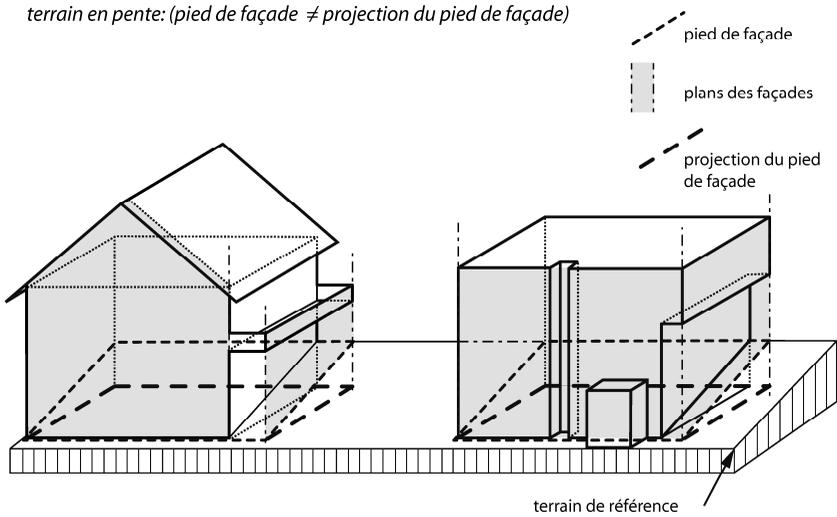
b Plans de façades et projection du pied de façade (sur terrain en pente)
